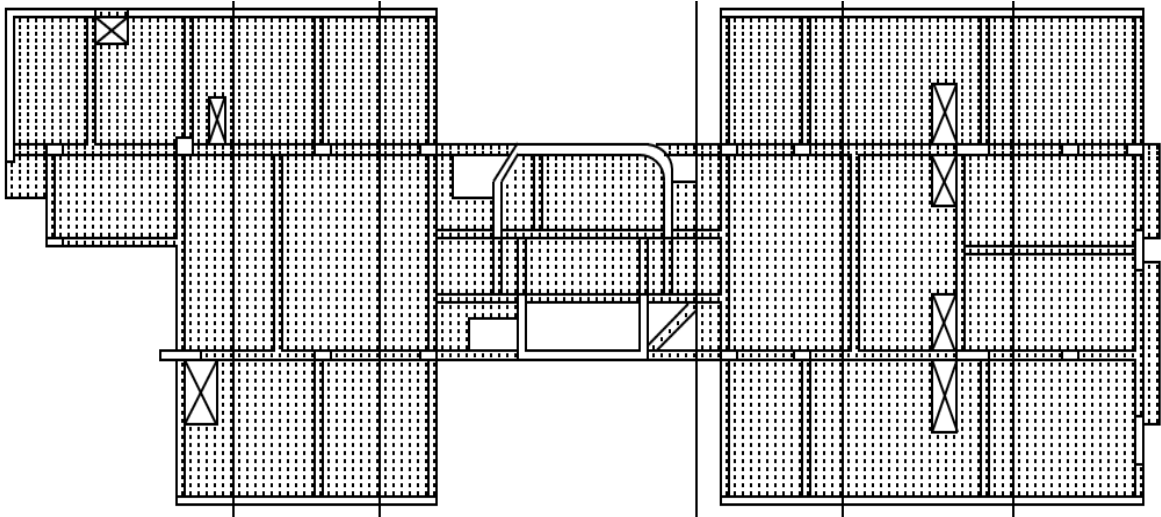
Metrado de elementos horizontales (Vigas y losa).
